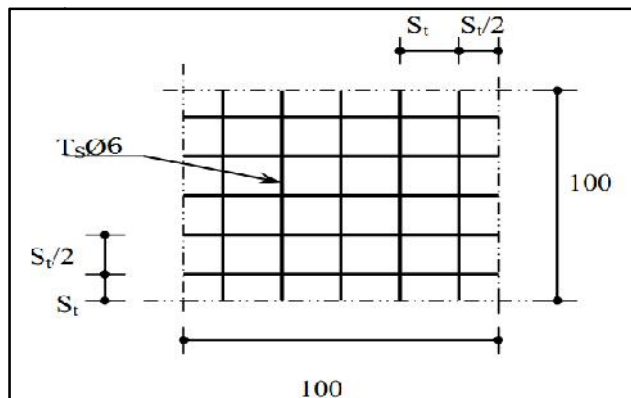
Disposition constructive des armatures de la table de compression.
